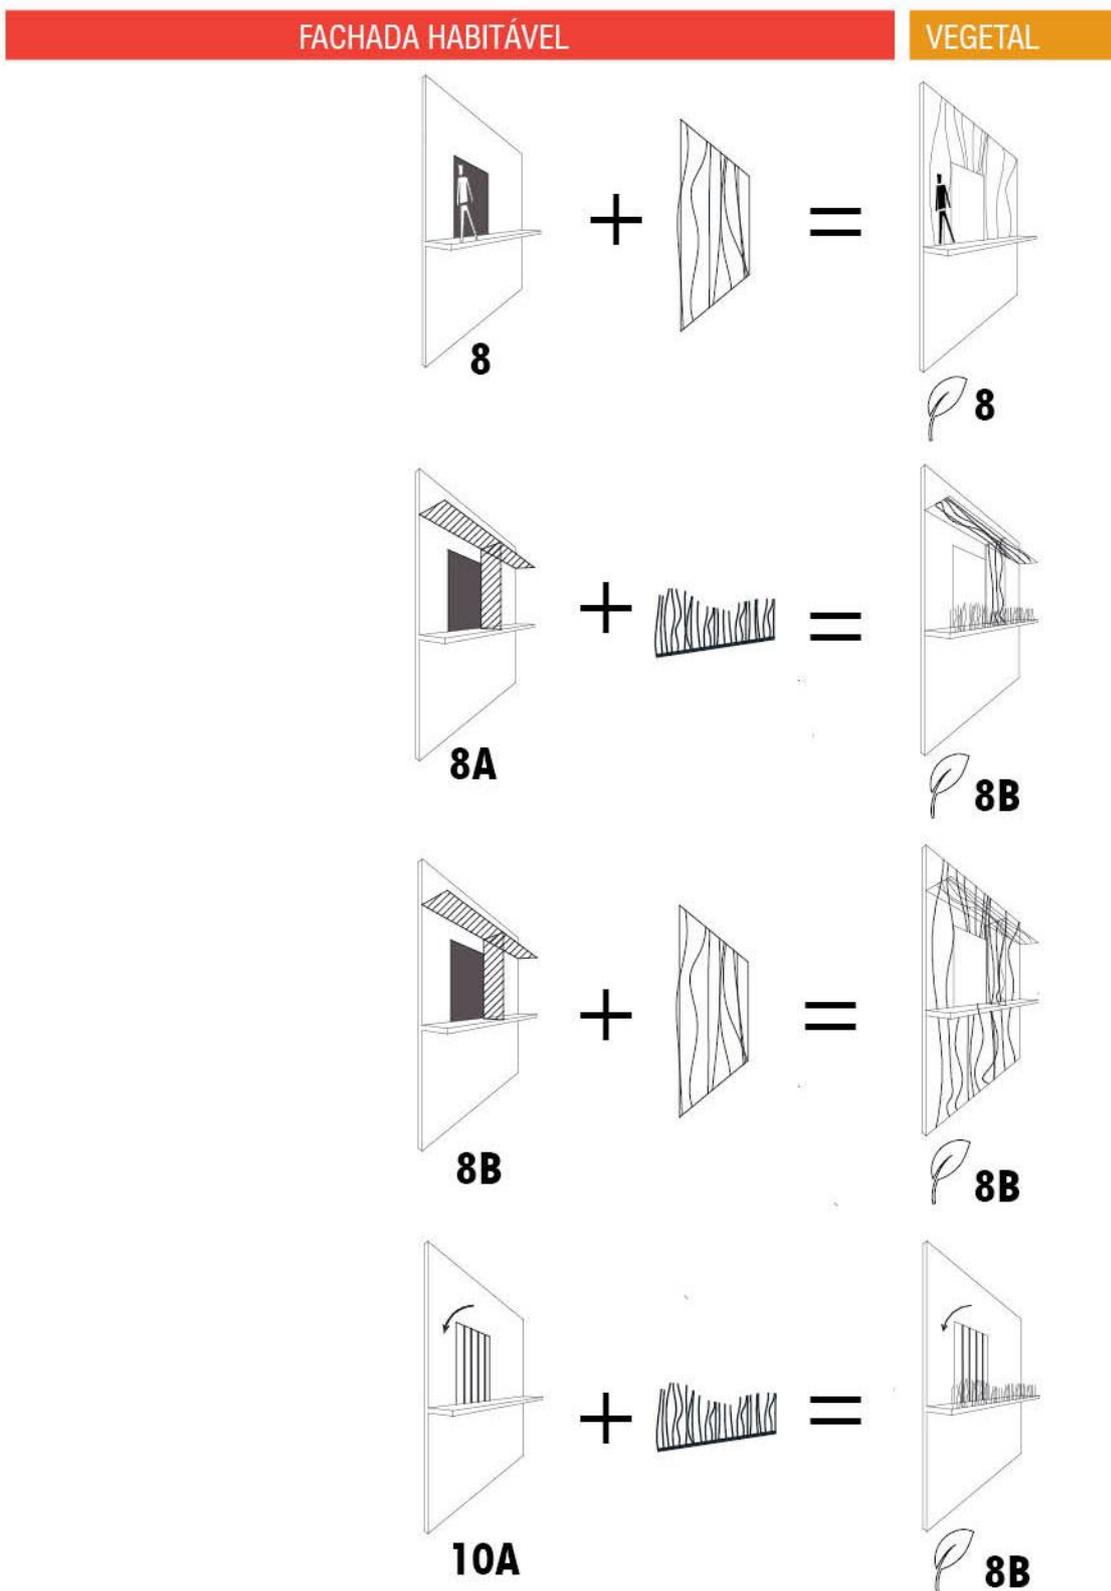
Fachadas Habitáveis- Camadas da Envolvente construtiva – parte II
